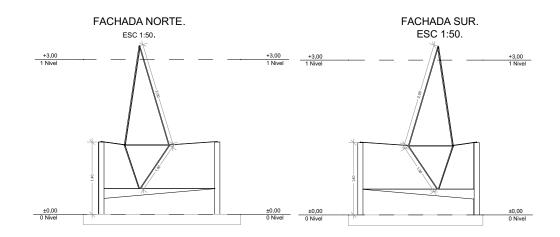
Fachadas Prototipo. Fuente: Elaboración propia.
